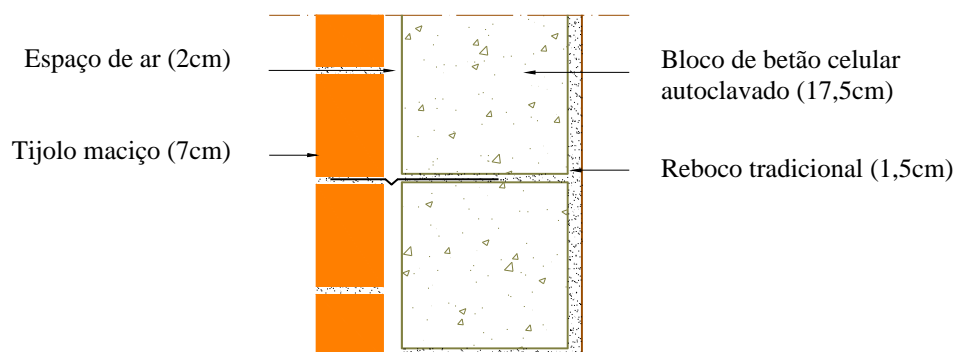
Parede dupla com pano exterior em alvenaria de tijolo maciço com face à vista e pano interior em alvenaria de blocos de betão celular autoclavado (Par4)
